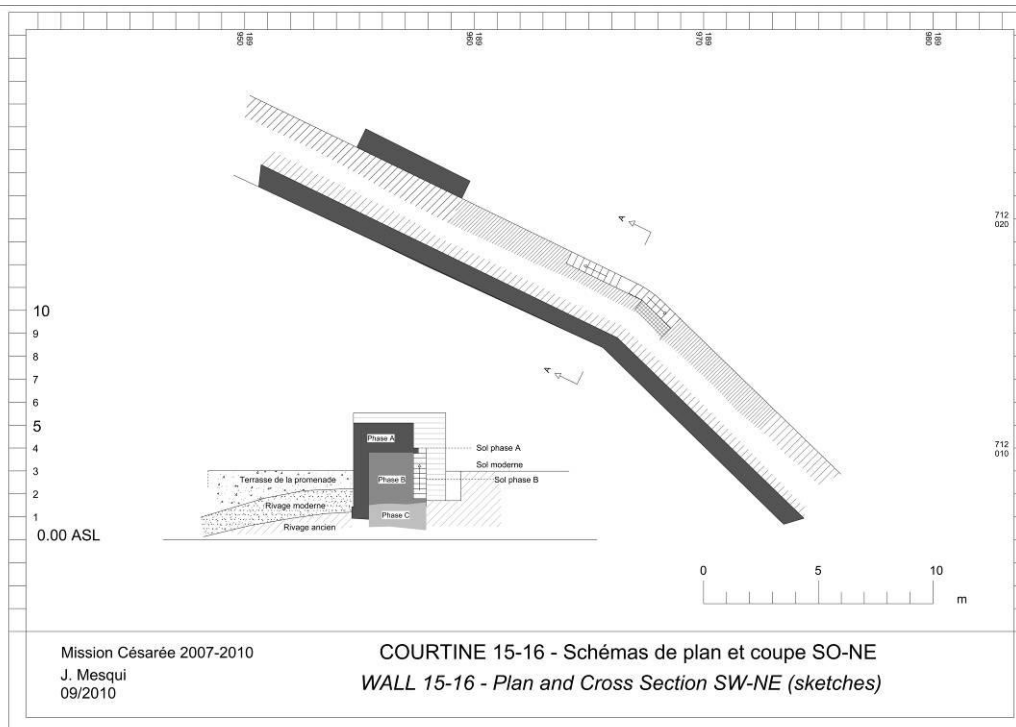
Schémas de plan et coupe de la zone fouillée au revers de la courtine 15-16
